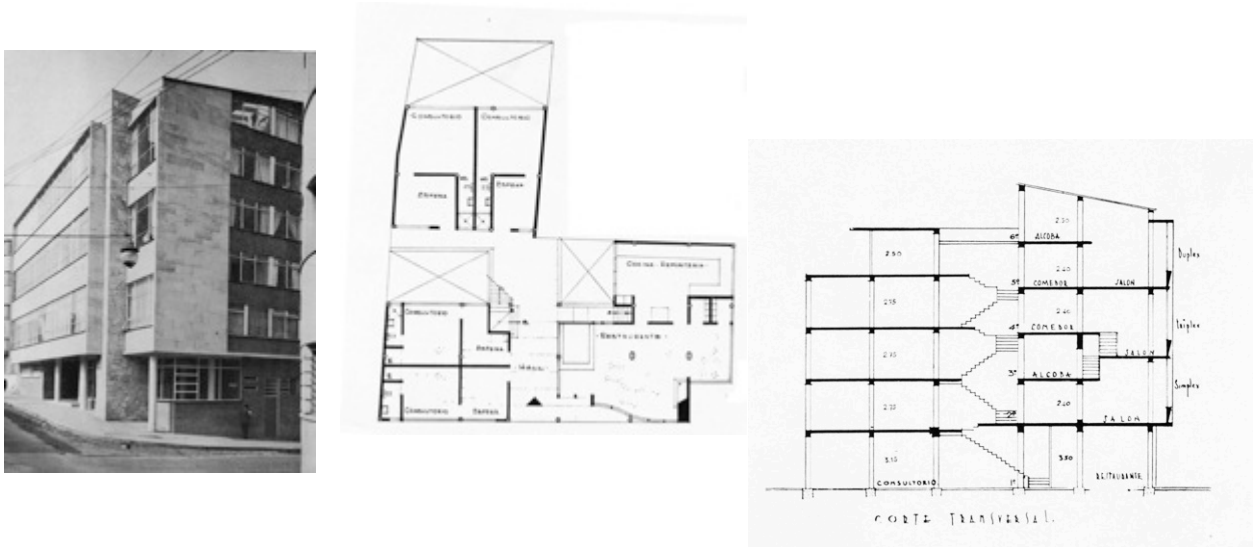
Fachada, planta y corte del edificio de la Beneficencia de Cundinamarca - Obregón y Valenzuela 1947.
